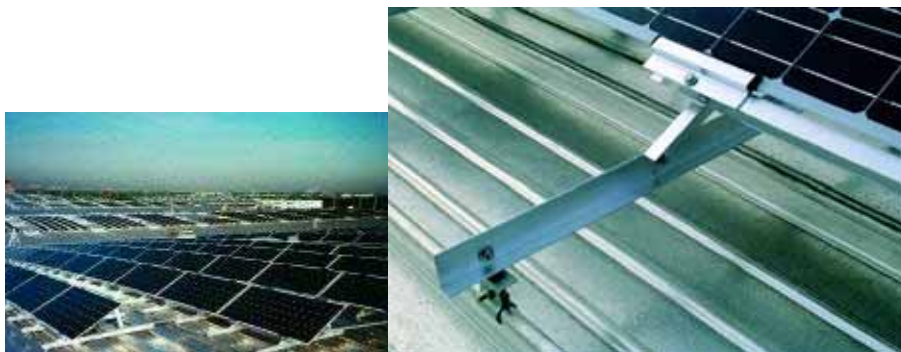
Grampos de cabeça arredondada para placas de rebordo KalZip, Trade Fair Centre em New Munich
